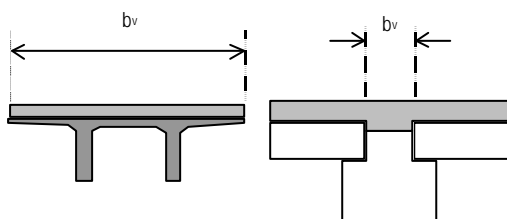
Ancho de contacto entre el elemento prefabricado y la losa colada en sitio
